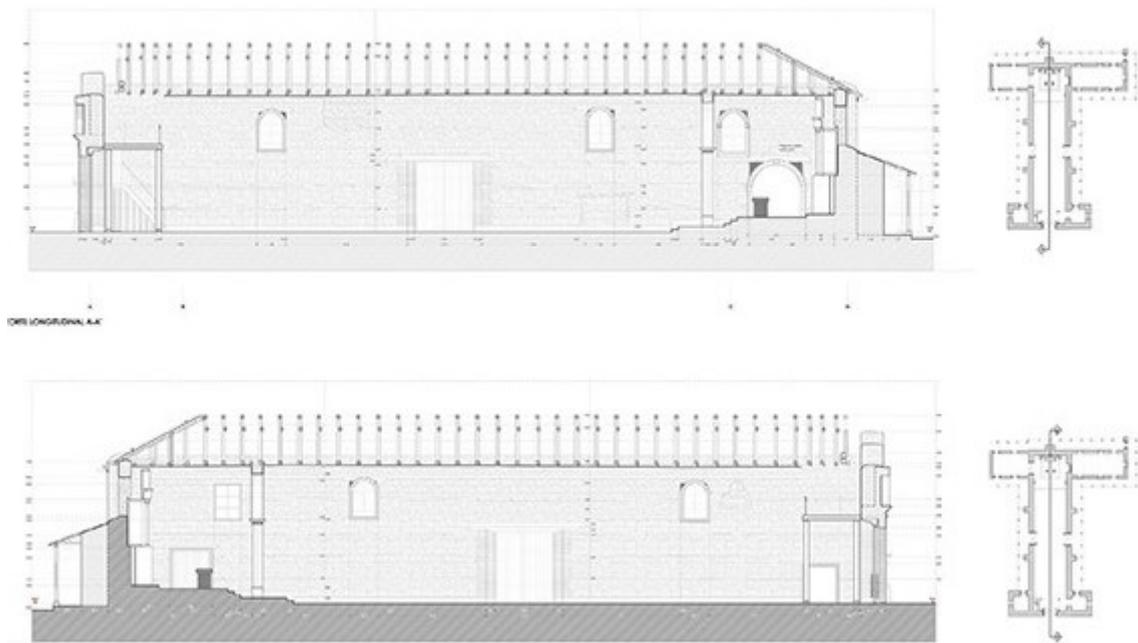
A. Alzados nave central Templo Parroquial intervenido en 2012; b) B. Planta del Templo Parroquial. (Cecrea, 2012).
